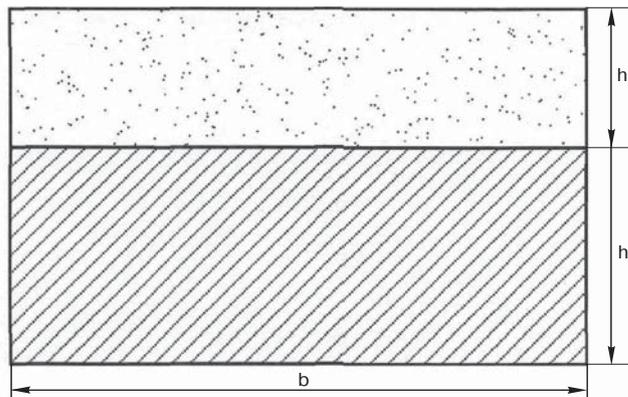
Расчетное поперечное сечение плиты с асфальтобетонным покрытием:  $h_a$  – толщина асфальтобетона,  $h$  – толщина цементобетона,  $b$  – ширина плиты
